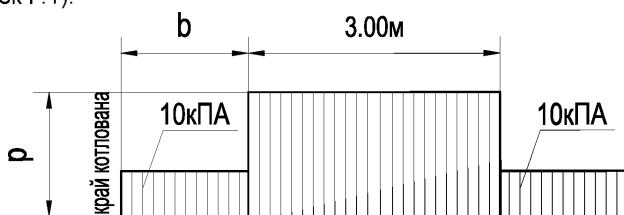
Вертикальная нагрузка на призме обрушения от автотранспорта
